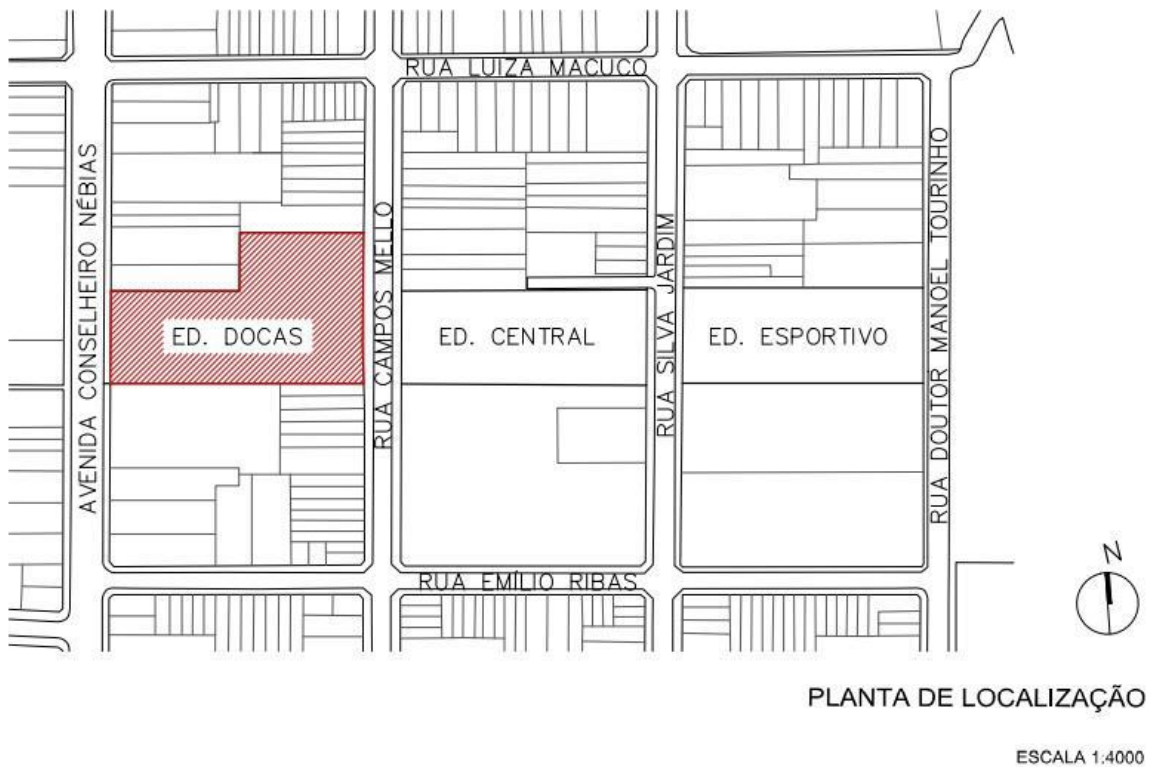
Imagem extraída do EIV, planta de localização do empreendimento.
